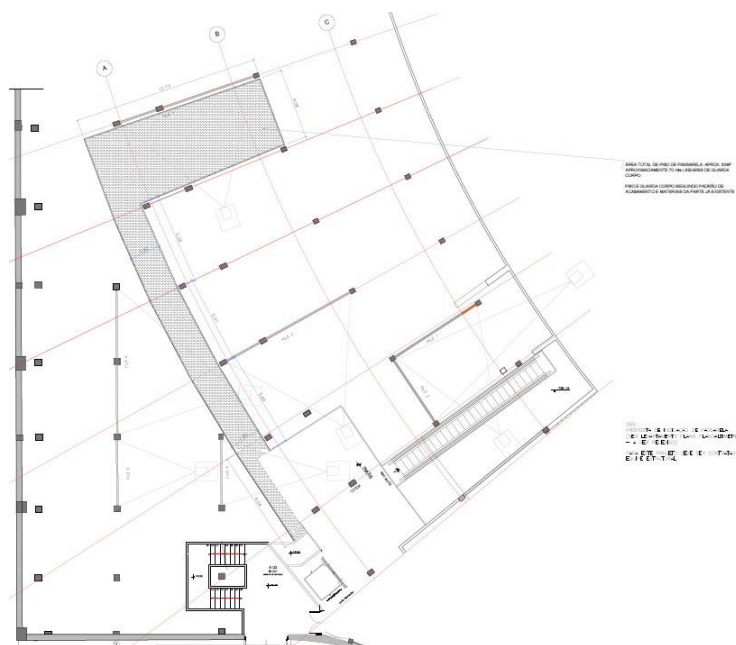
Planta com o estudo preliminar da passarela da Exaltação
